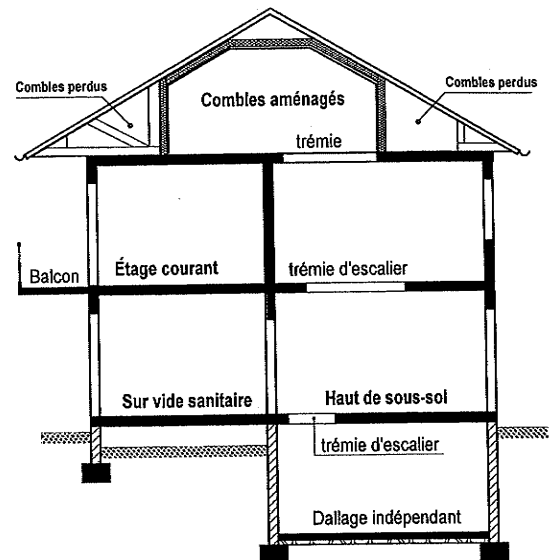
Planchers : sur sous-sol, sur vide sanitaire, d'étage.
